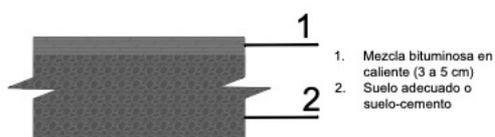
Sección tipo pavimento mezcla asfáltica.
